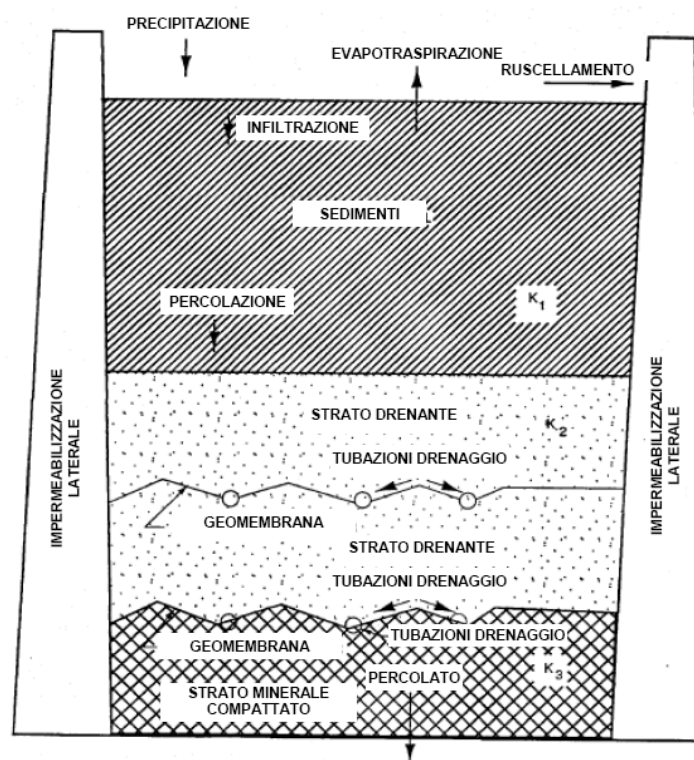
Rappresentazione generale della struttura del sistema sedimenti + barriera a bassa permeabilità nel modello HELP
